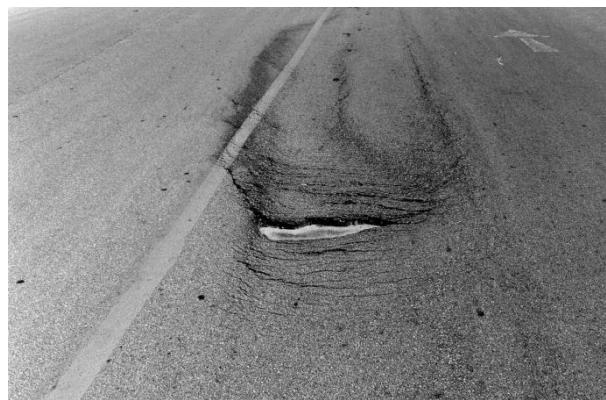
Поверхностная колея на покрытии, сопровождаемая просадкой асфальтобетона
